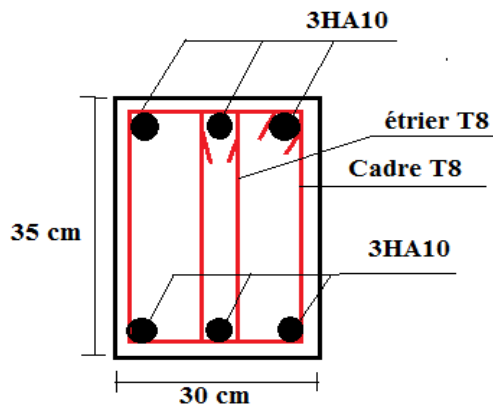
Schémas de ferrailage de la poutre de chaînage
